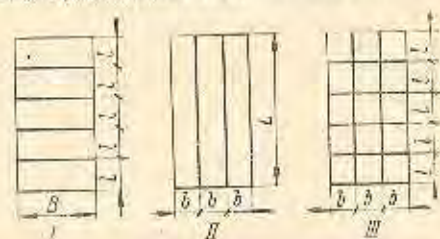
Основные схемы укрепления прямоугольной плоской стенки ребрами:
